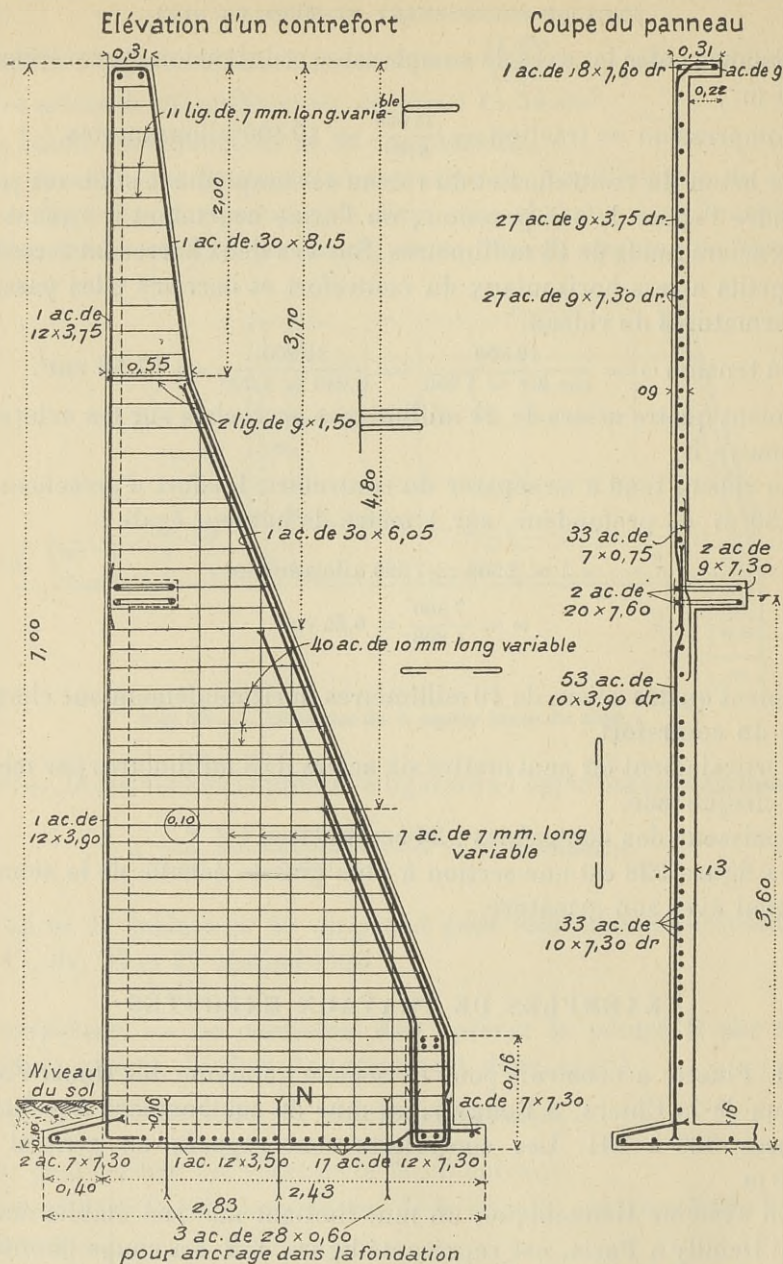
et 330. — Mur de soutènement à Longwy, armature d'un contrefort et du rideau.
